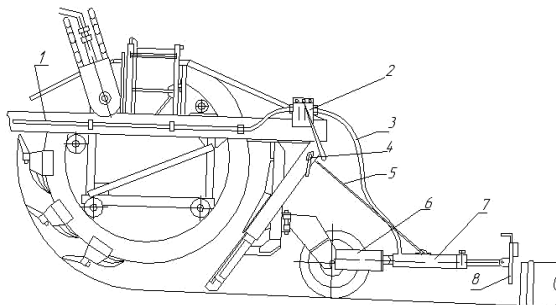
Стыковочное приспособление на роторном экскаваторе:
